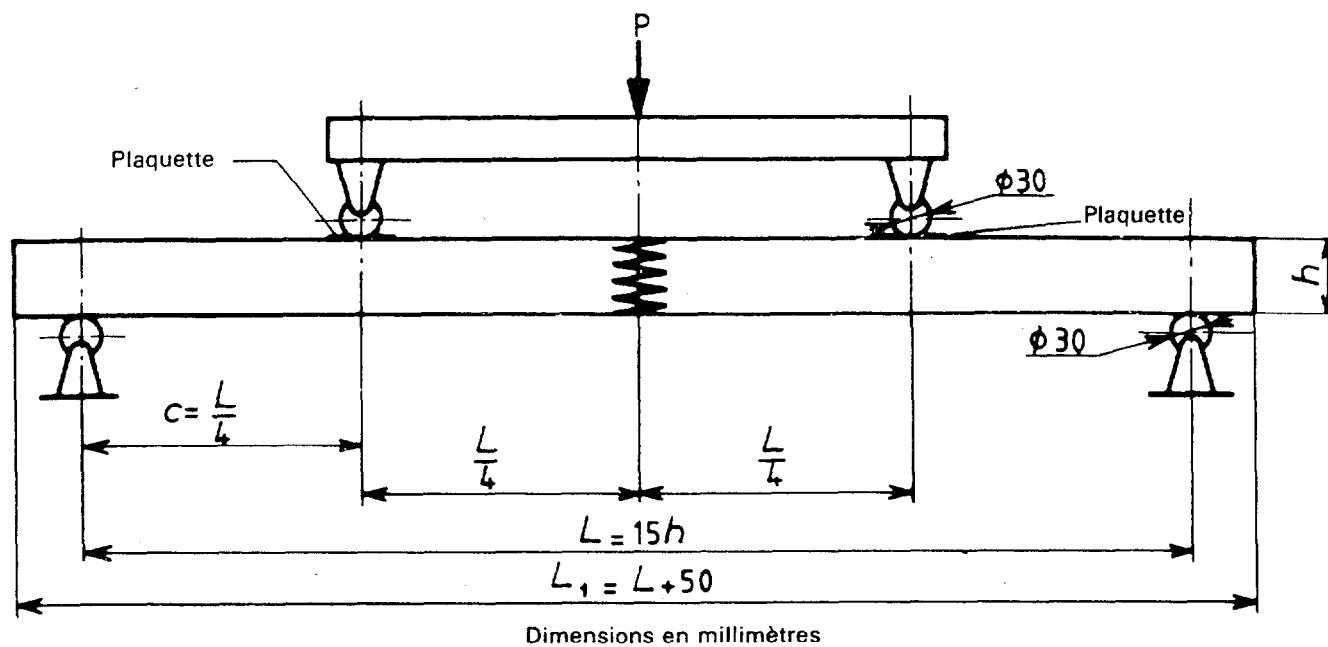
Principe du dispositif d'essai — Positions relatives de l'éprouvette et des cylindres
